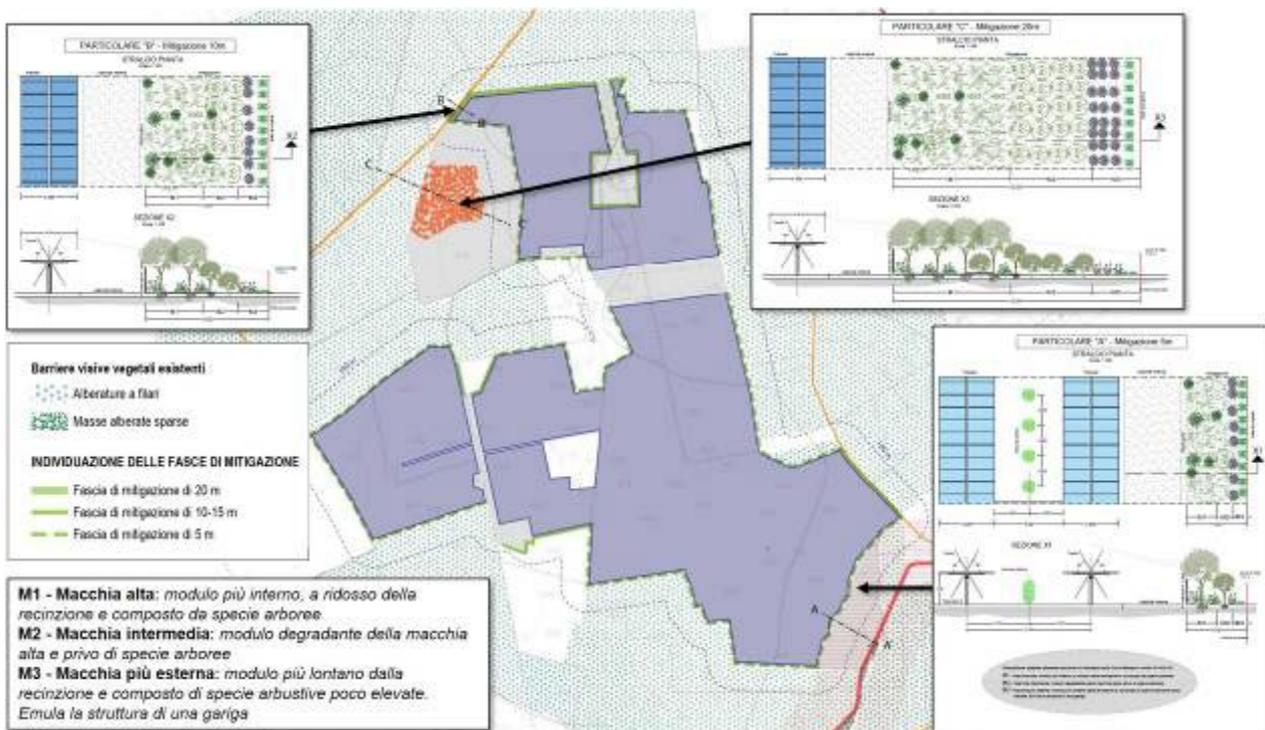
Fasce di mitigazione campo agrovoltaiico: larghezza 5 m (Particolare “A”), larghezza 10 m (Particolare “B”) e larghezza 20 m (Particolare “C”)
